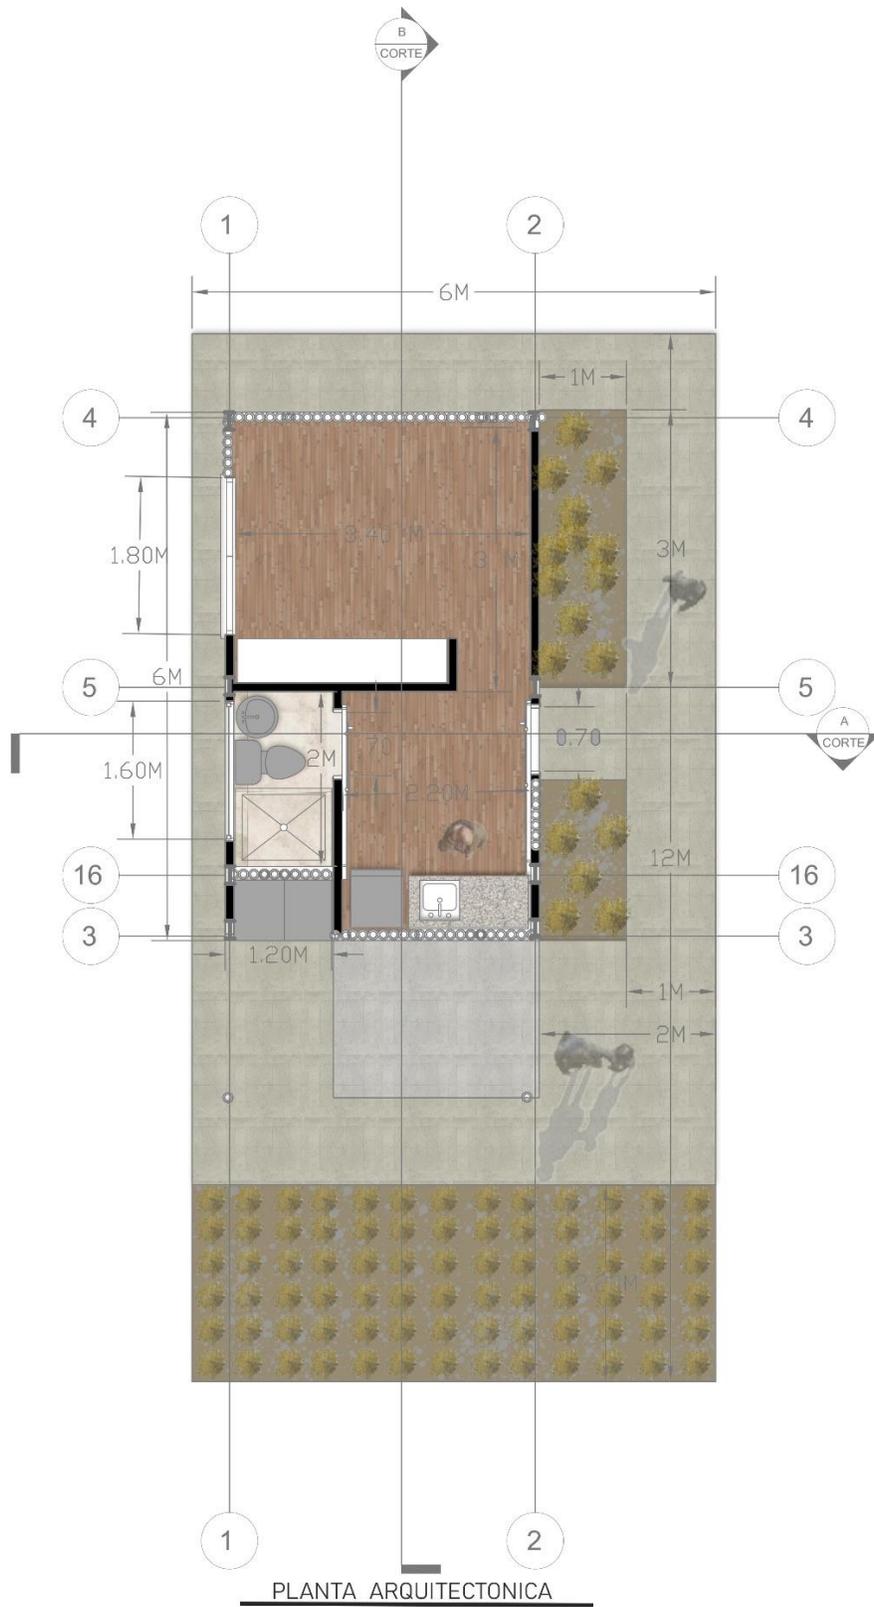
Planta Arquitectónica Prototipo unidad básica
